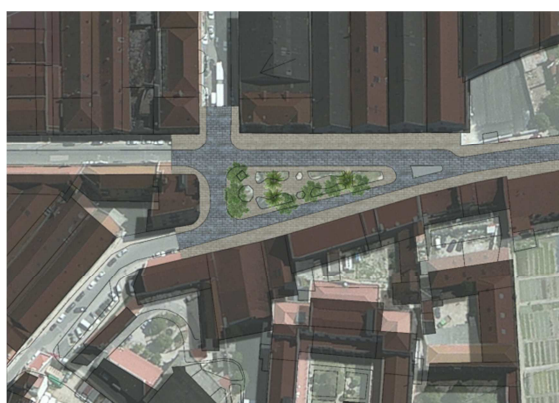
| Situação proposta para a Praça David Leandro da Silva.
